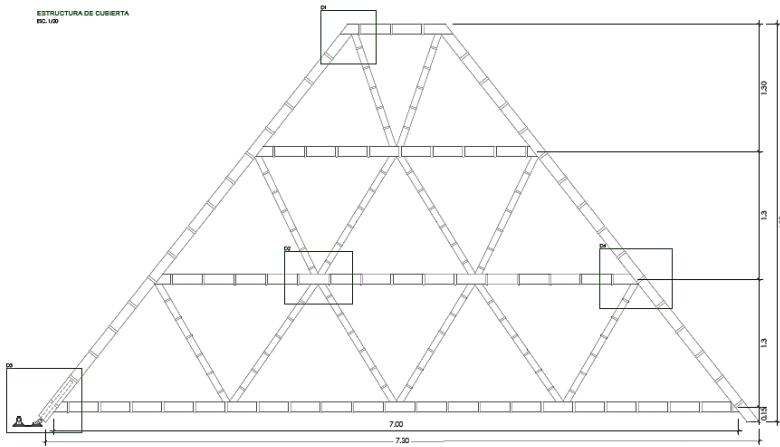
Sección de estructura de bambú de la cubierta del módulo. Fuente: Elaboración propia.
